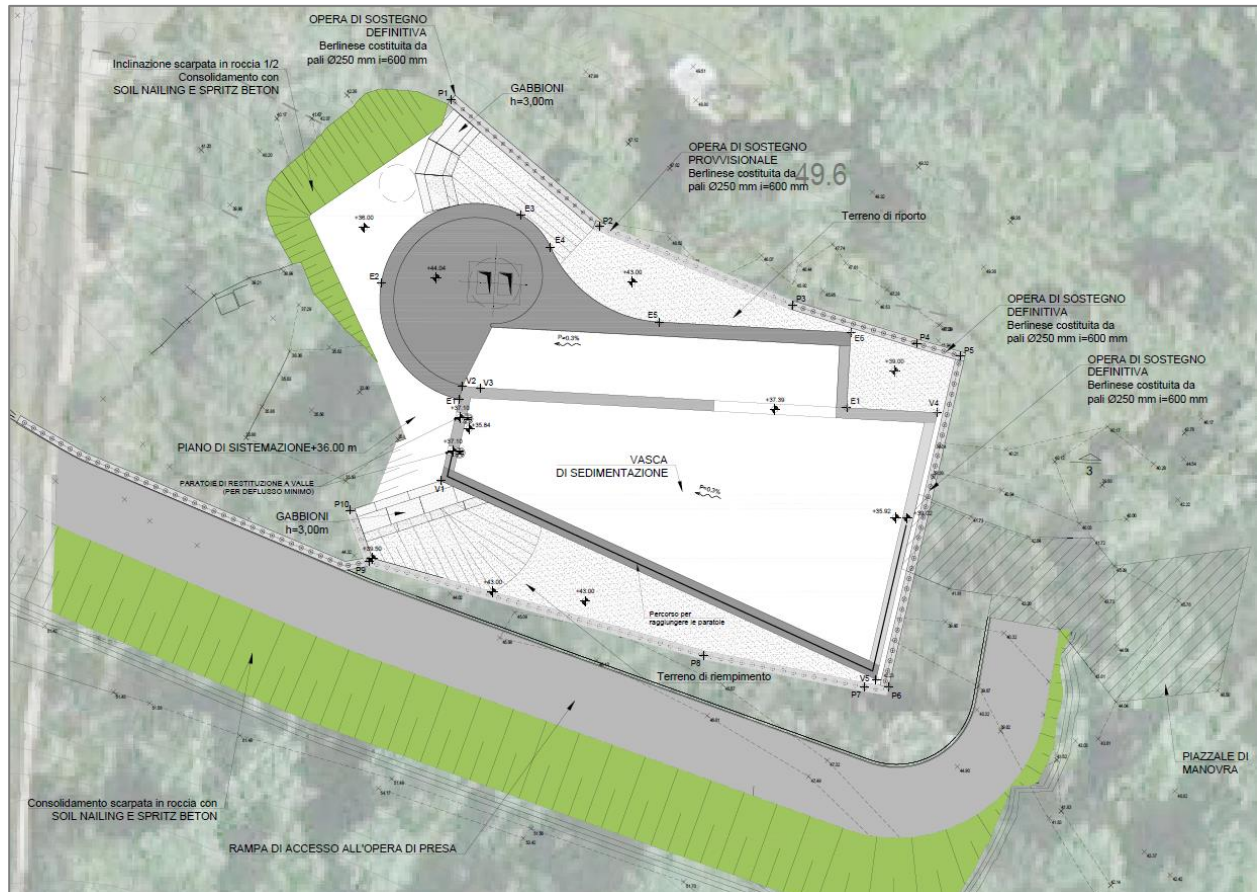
Planimetria generale di progetto dell'opera di presa
